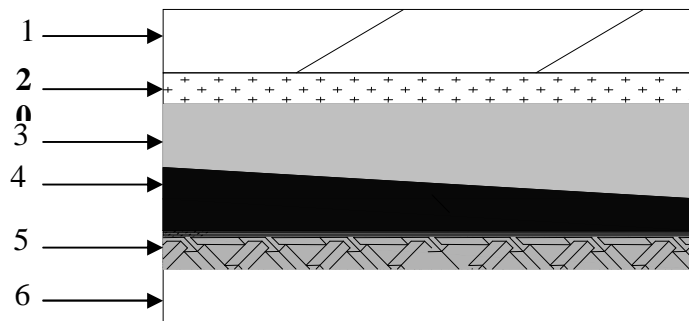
4. a : Coupe transversale du plancher terrasse inaccessible.
